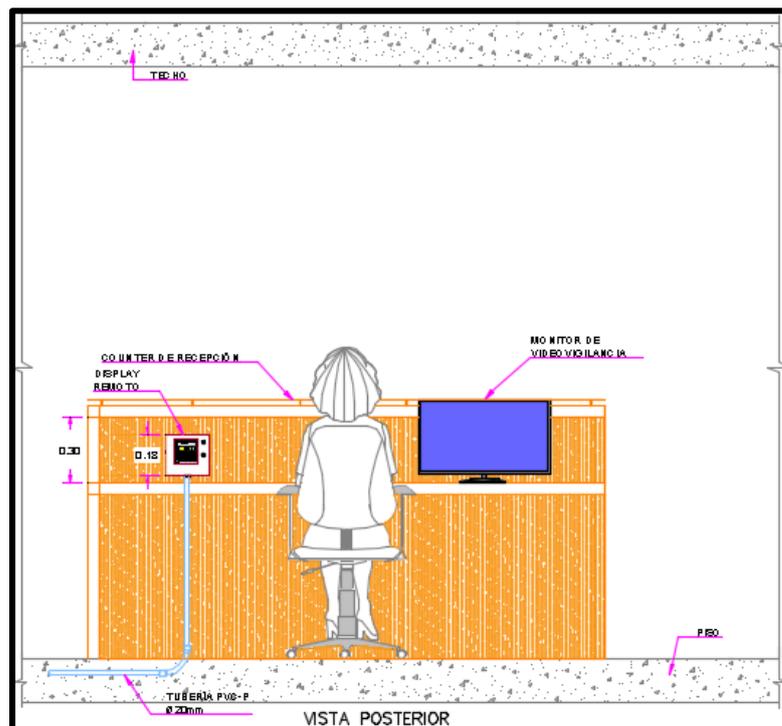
Display Remoto en Plano de Detalles (Vista Posterior)
